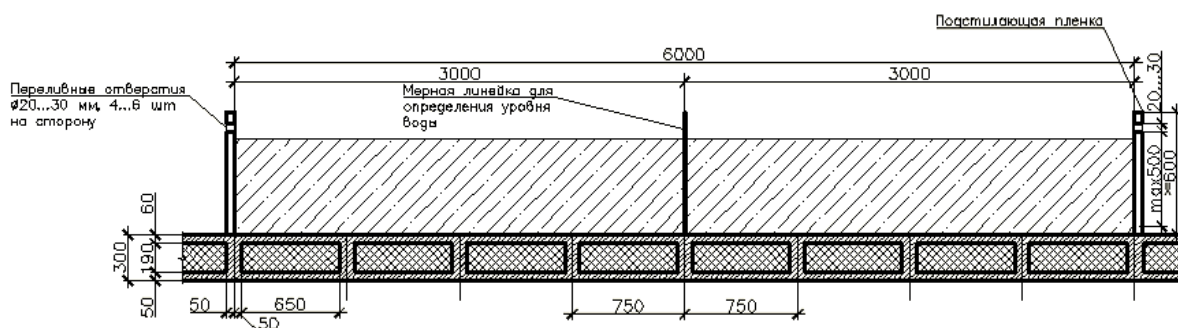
Поперечное сечение перекрытия и системы нагружения.
